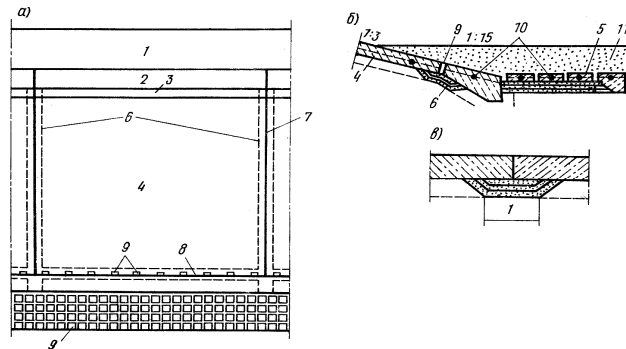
Крепление верхового откоса земляной плотины большими монолитными железобетонными плитами:
